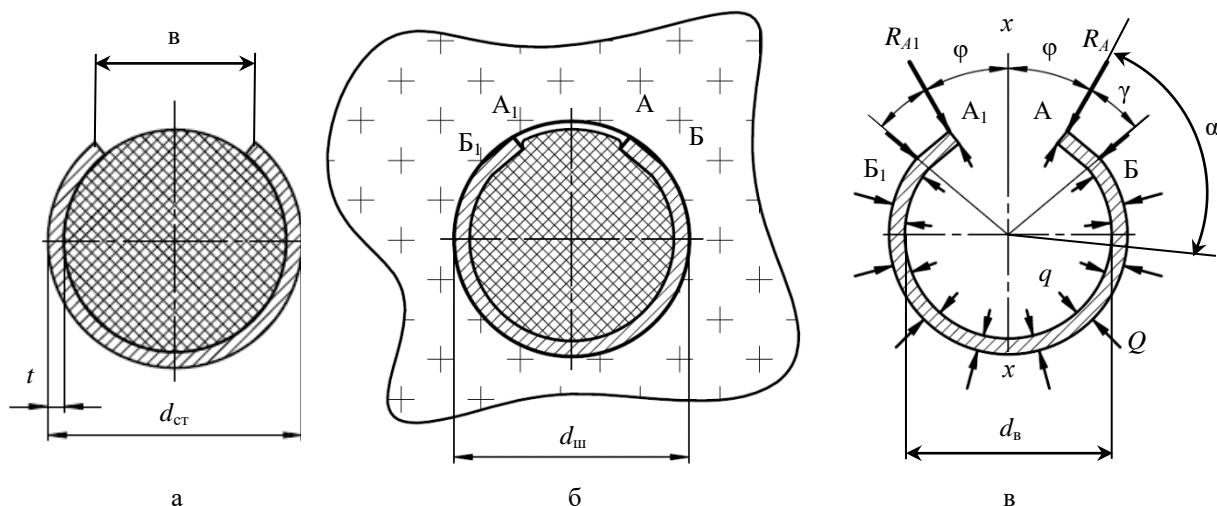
Поперечное сечение, выполненное в передней части стержня: а – сечение стержня анкера до установки в шпур; б – сечение после установки в шпур; в – схема нагружения стержня анкера
